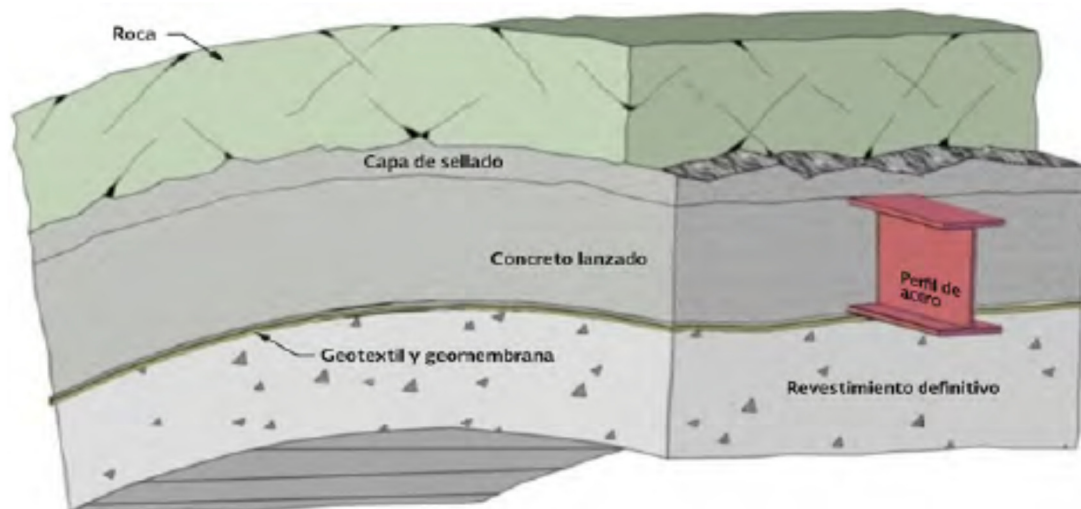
Sistema de impermeabilización en túneles (en sándwich).
